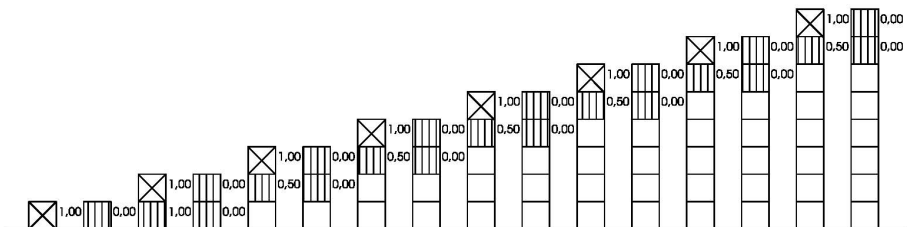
Factor de carga, en los puntales, con una planta cimbrada y otra recimbrada, en un edificio de ocho plantas, sobre solera infinitamente rígida.
